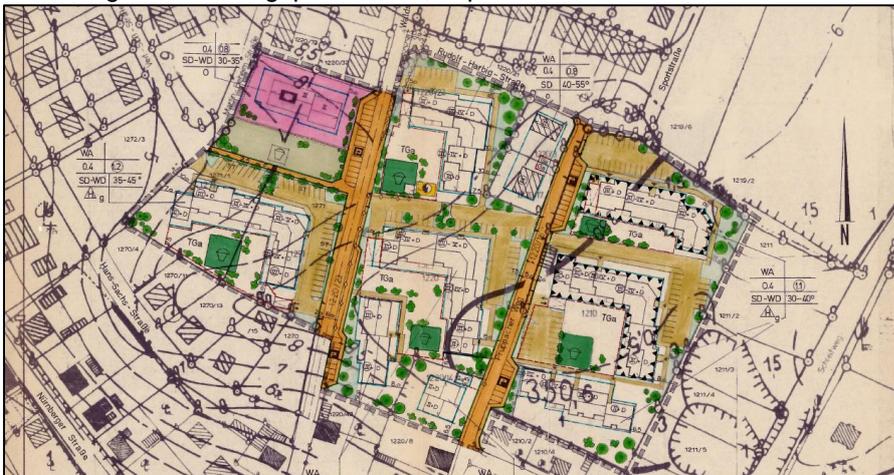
Bebauungsplan Nr. 66, 3. Änderung
